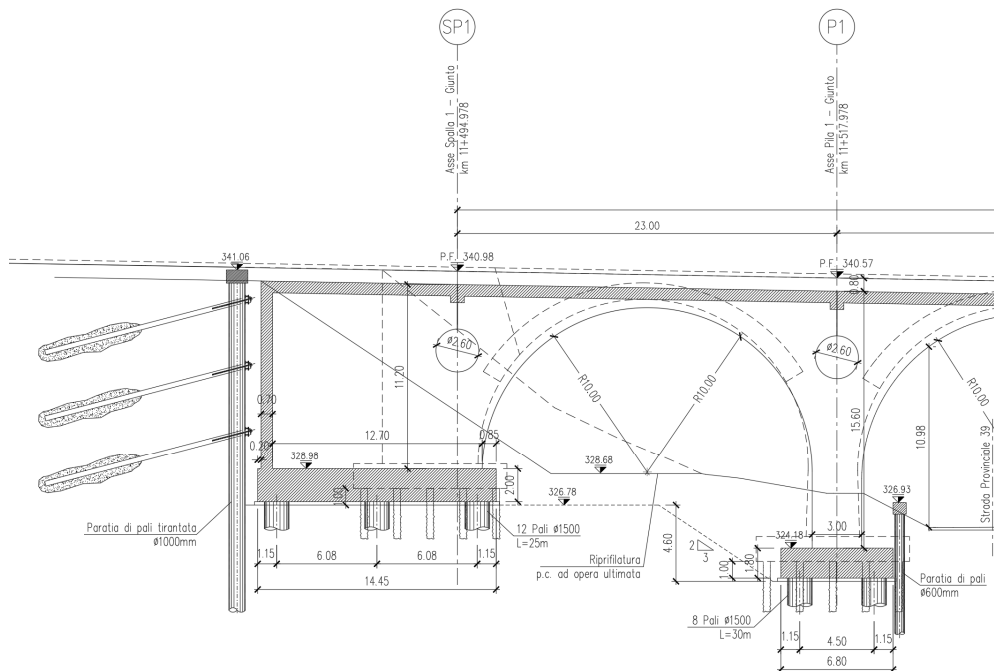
Sezione longitudinale cassone spalla 1 e primo arco
